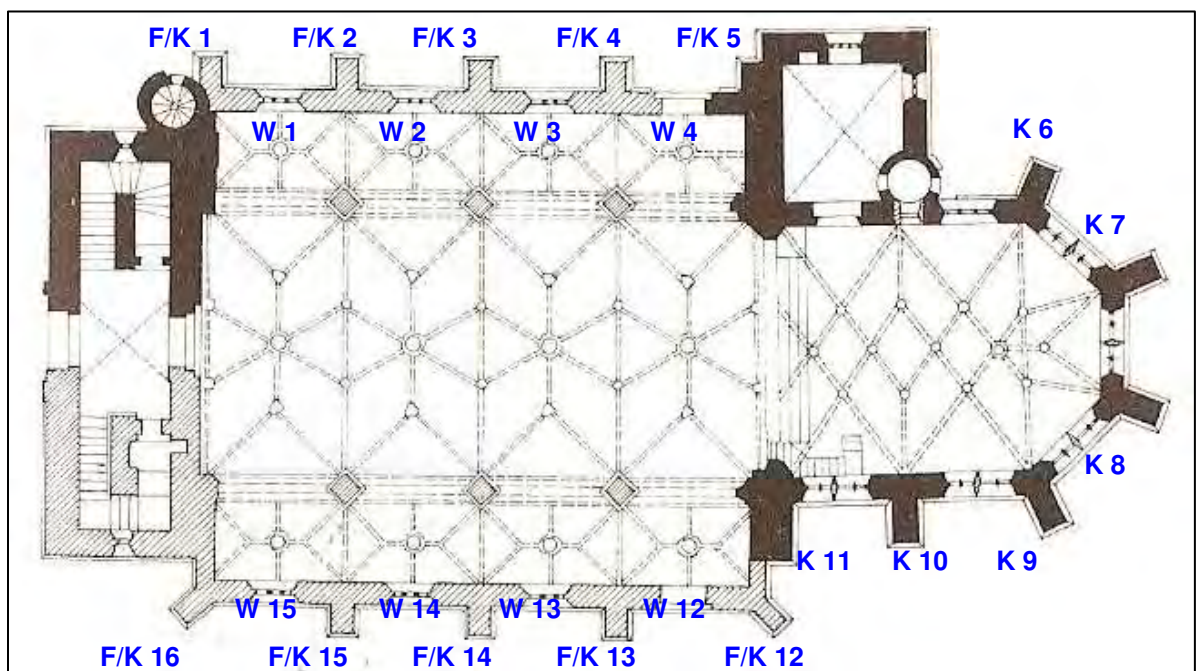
Grundriss der Kirche mit Bezeichnung der Bauteile
